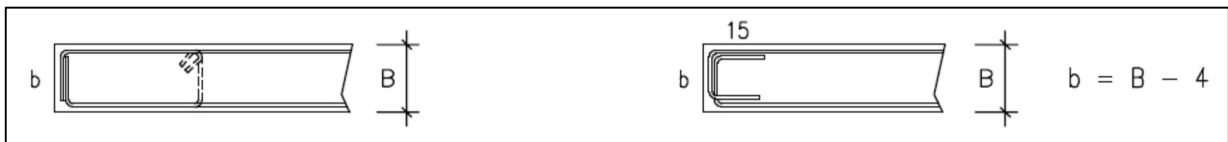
DETALLE DOBLEDO MALLA CABEZA MURO CON ESTRIBO Y SIN ESTRIBO.
